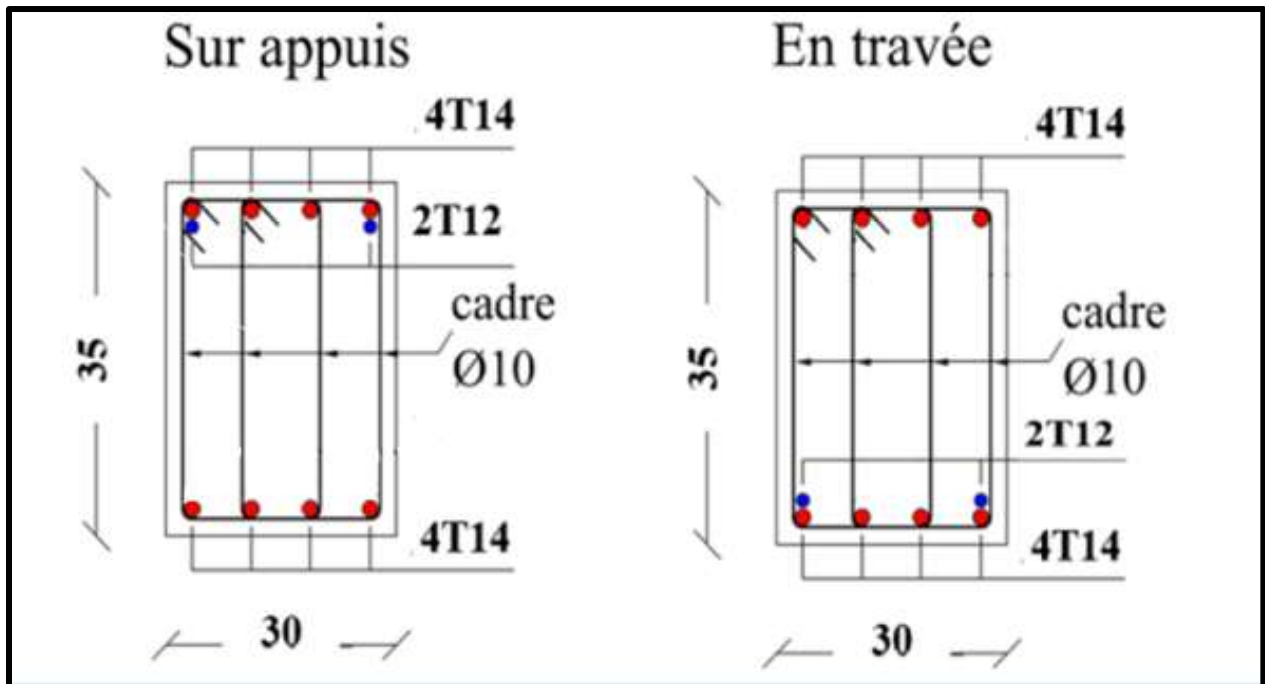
Ferrailage de la poutre secondaire (Zone 02)
